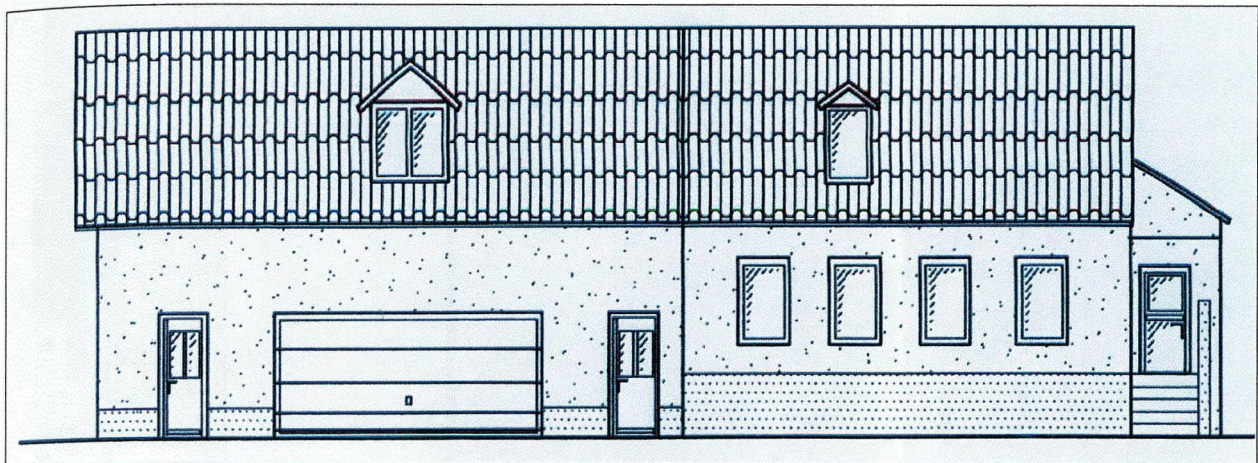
Ansicht von Norden des geplanten Garagenanbaues mit seiner Anpassung an das Betriebs-Wohnhaus der Familie Keil (Entwurf: Udo Rank).
